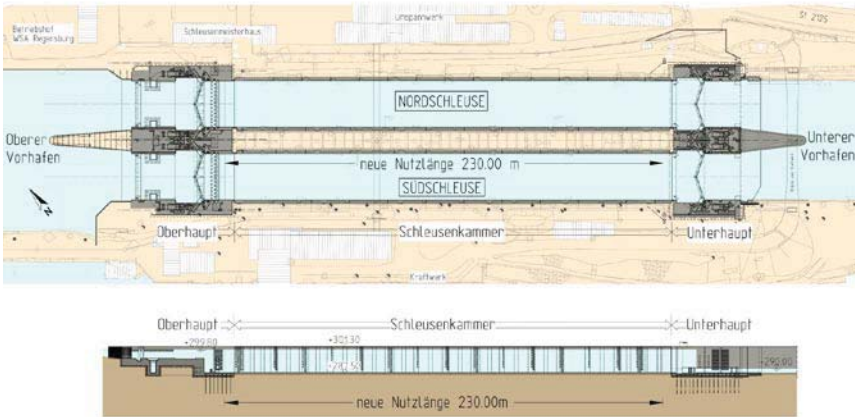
Grundriss und Längsschnitt der geplanten Grundinstandsetzung
